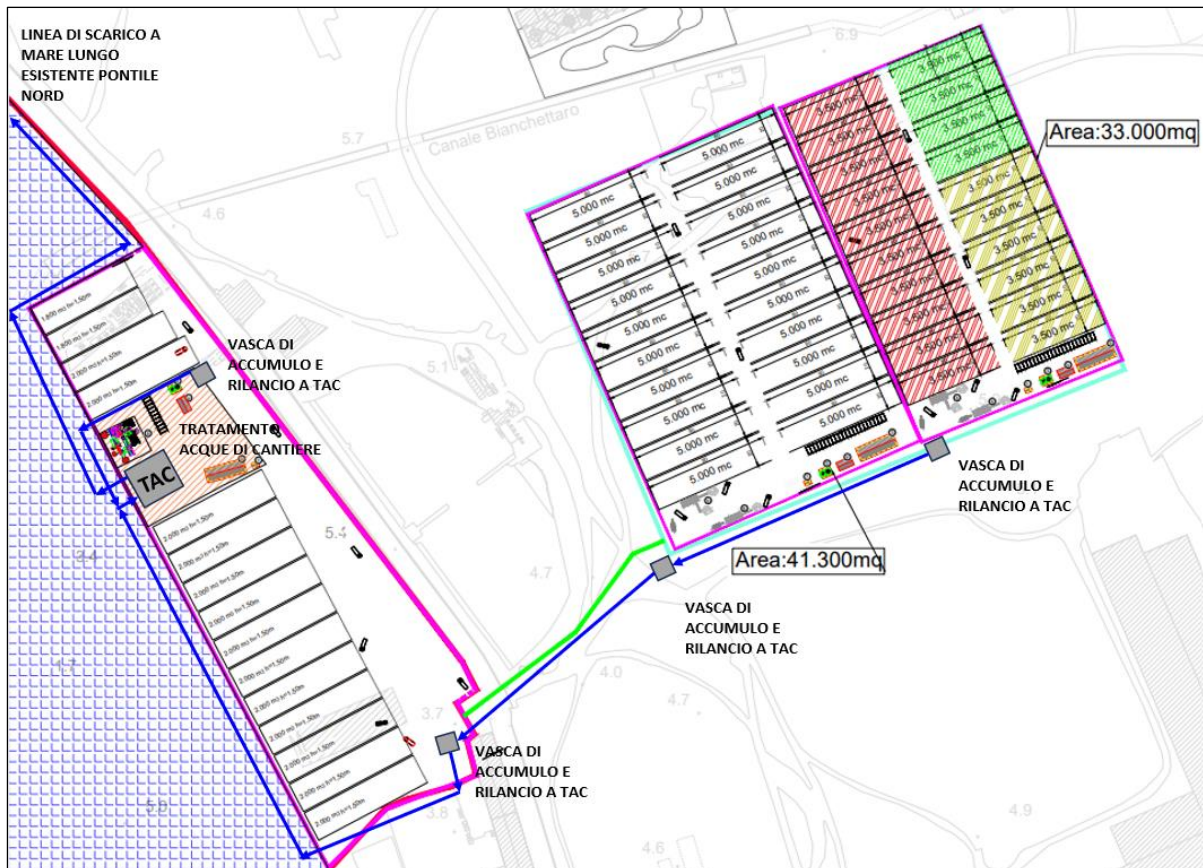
Schema planimetrico di accumulo e rilancio delle acque di cantiere
